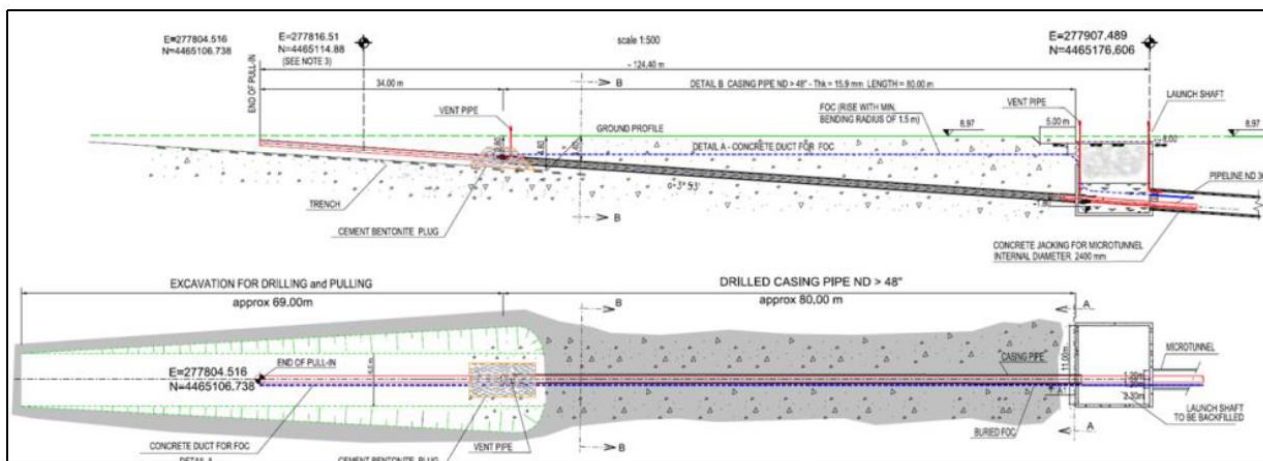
Sezione e pianta del tubo camicia di protezione (Fonte: SAIPEM 2016).
